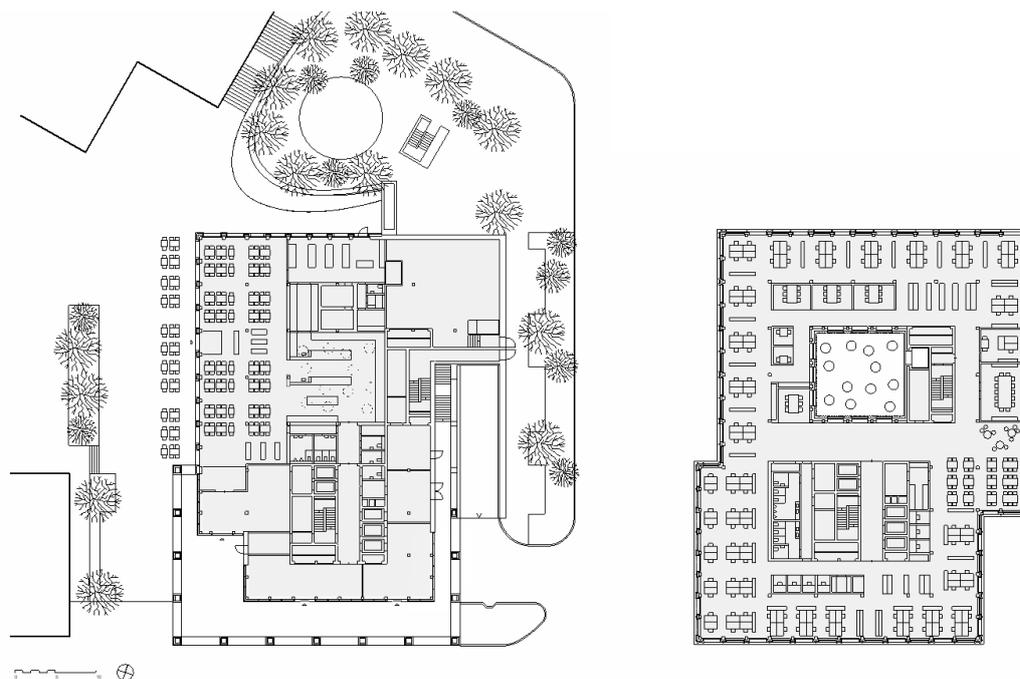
Grundrisse Erdgeschoss und Regelgeschoss (1.-5. Obergeschoss)
